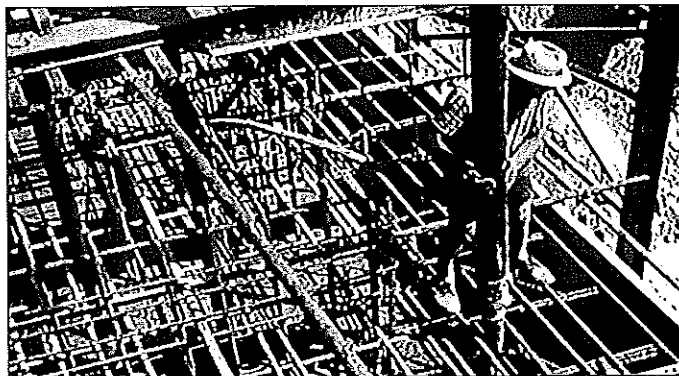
Un getto di calcestruzzo superfluido (S5) in opera fortemente armata
